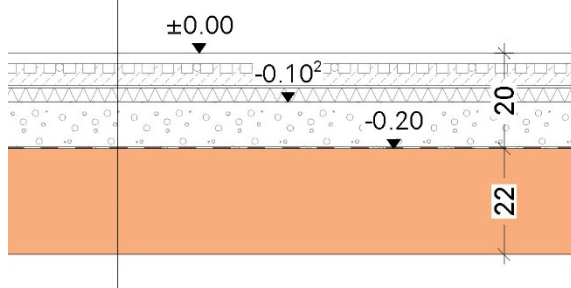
Fallbeispiel: Deckenaufbau (Zeichnung: Lattke Architekten)
